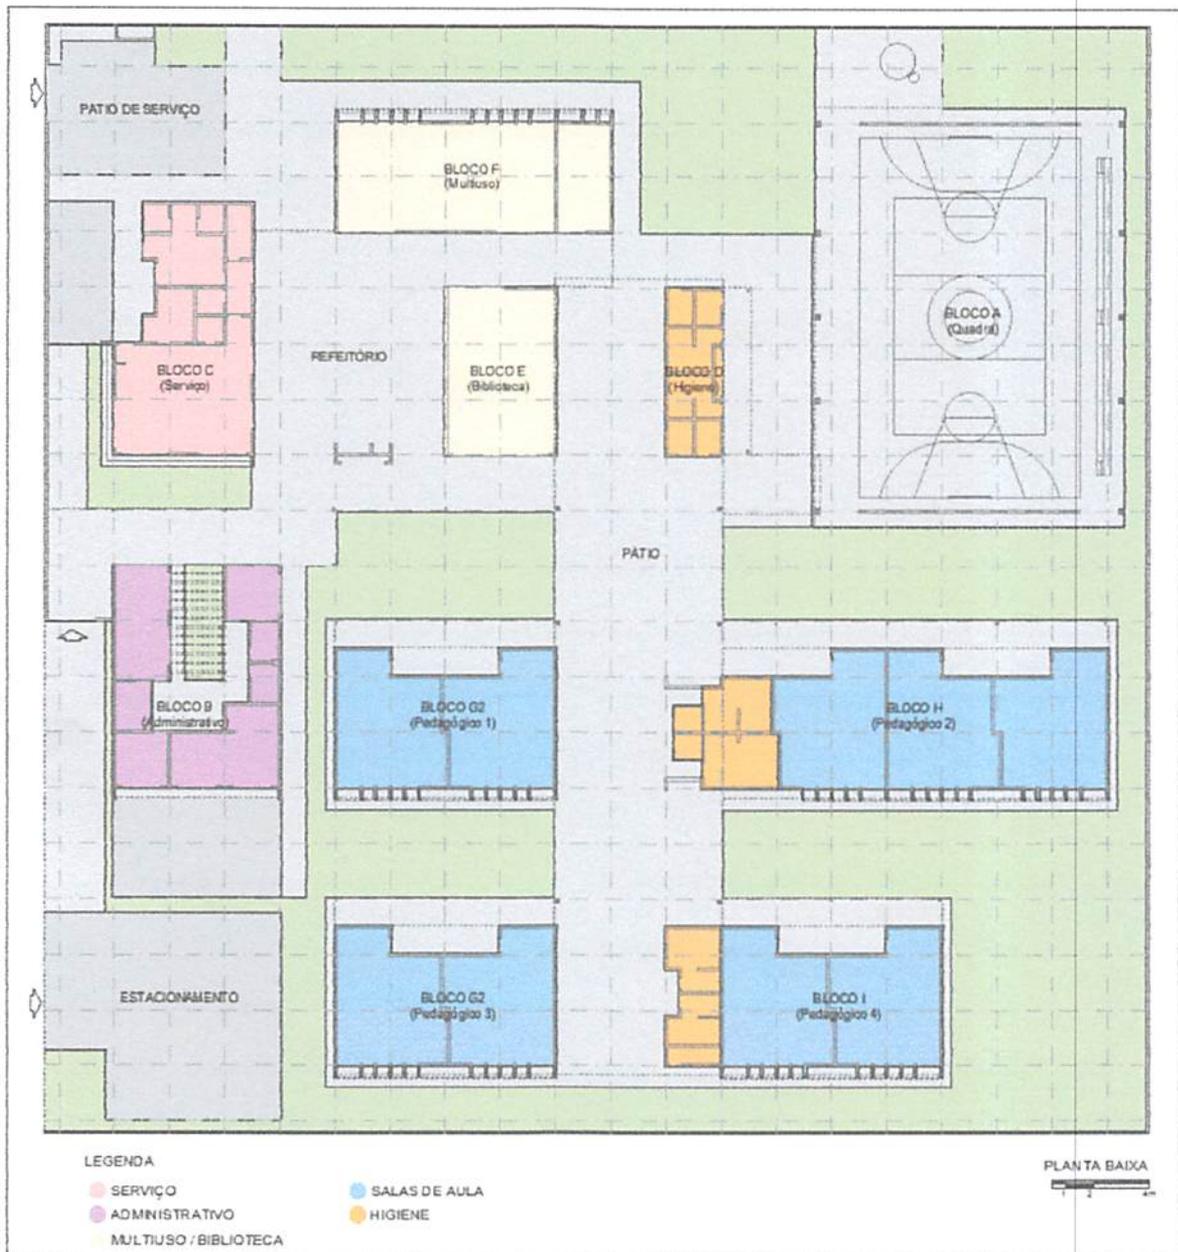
planta baixa de implantação dos blocos – Escola 9 Salas - Térreo
